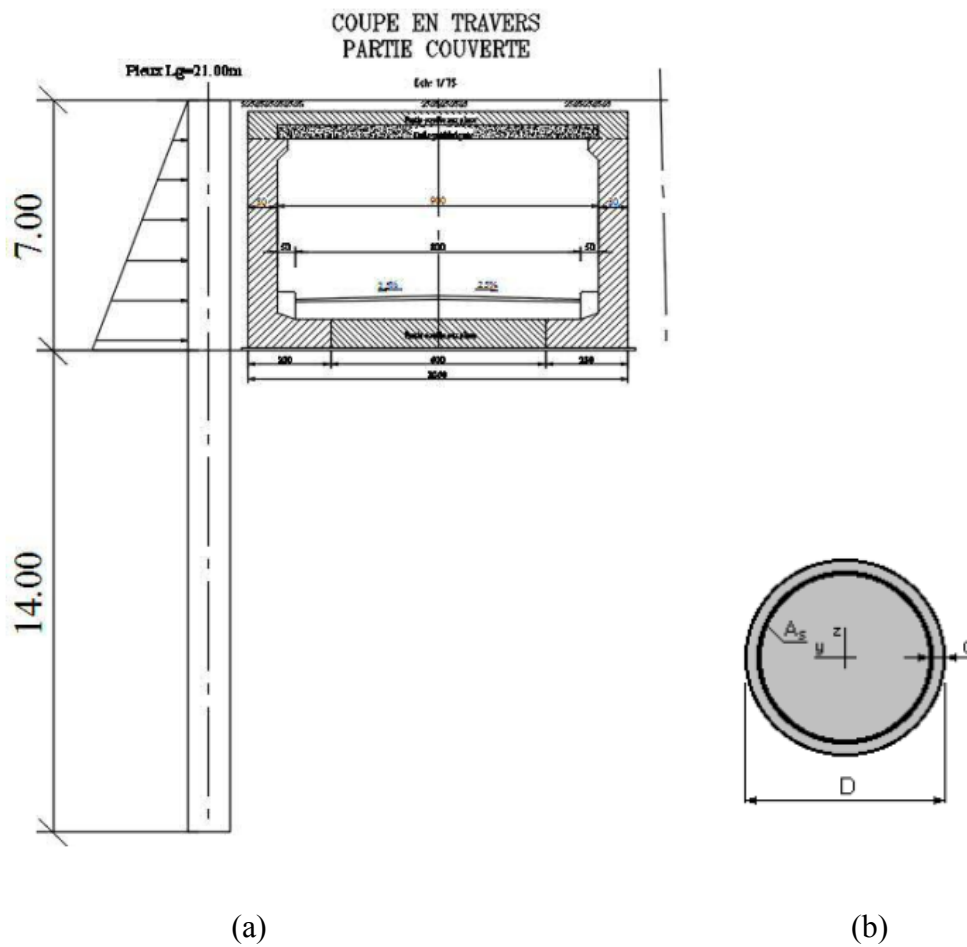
(a) coupe en travers de la section étudié, (b) diamètre du pieu
